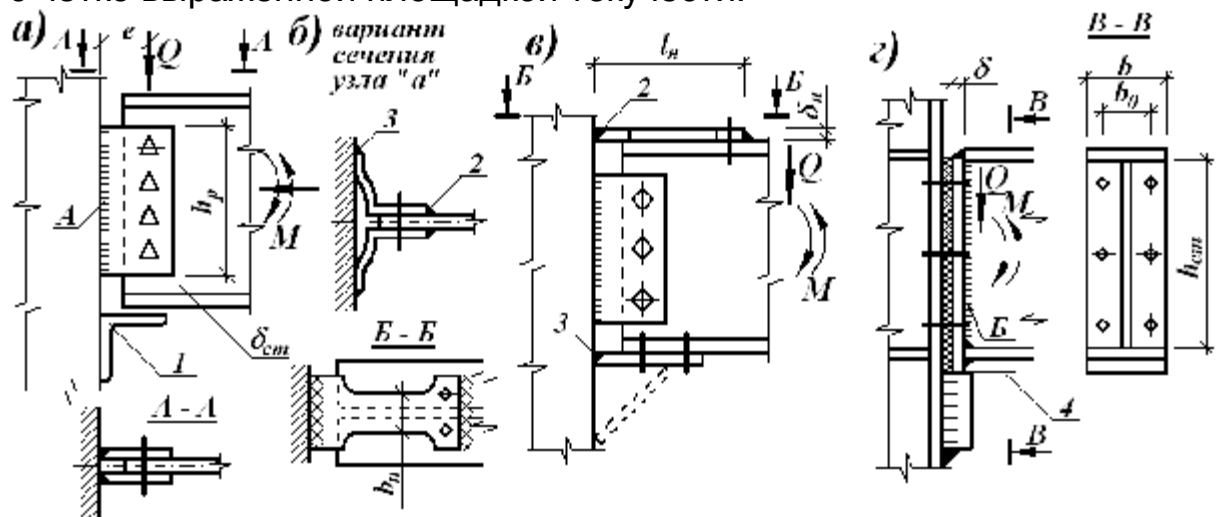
Гибкое прикрепление балки к колонне. 1 – монтажный столик; 2 – монтажный сварной шов; 3 - заводской сварной шов; 4 – плоскость обработки.
